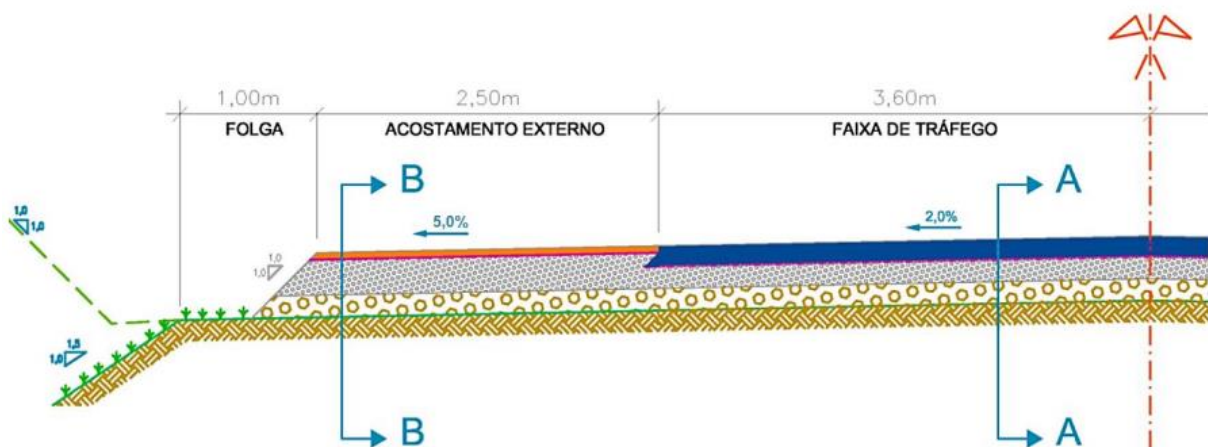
Seção tipo rodovia classe I (pavimentos novos) para levantamento de custos
